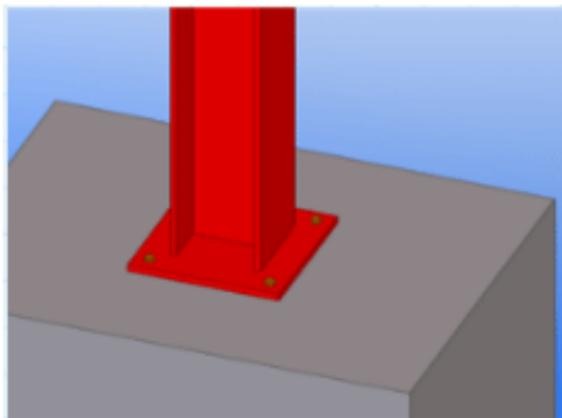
Sistema emperrado de platinas o placa asiento.
